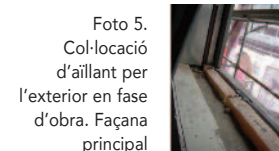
Col·locació d'aïllant per l'exterior en fase d'obra. Façana principal
